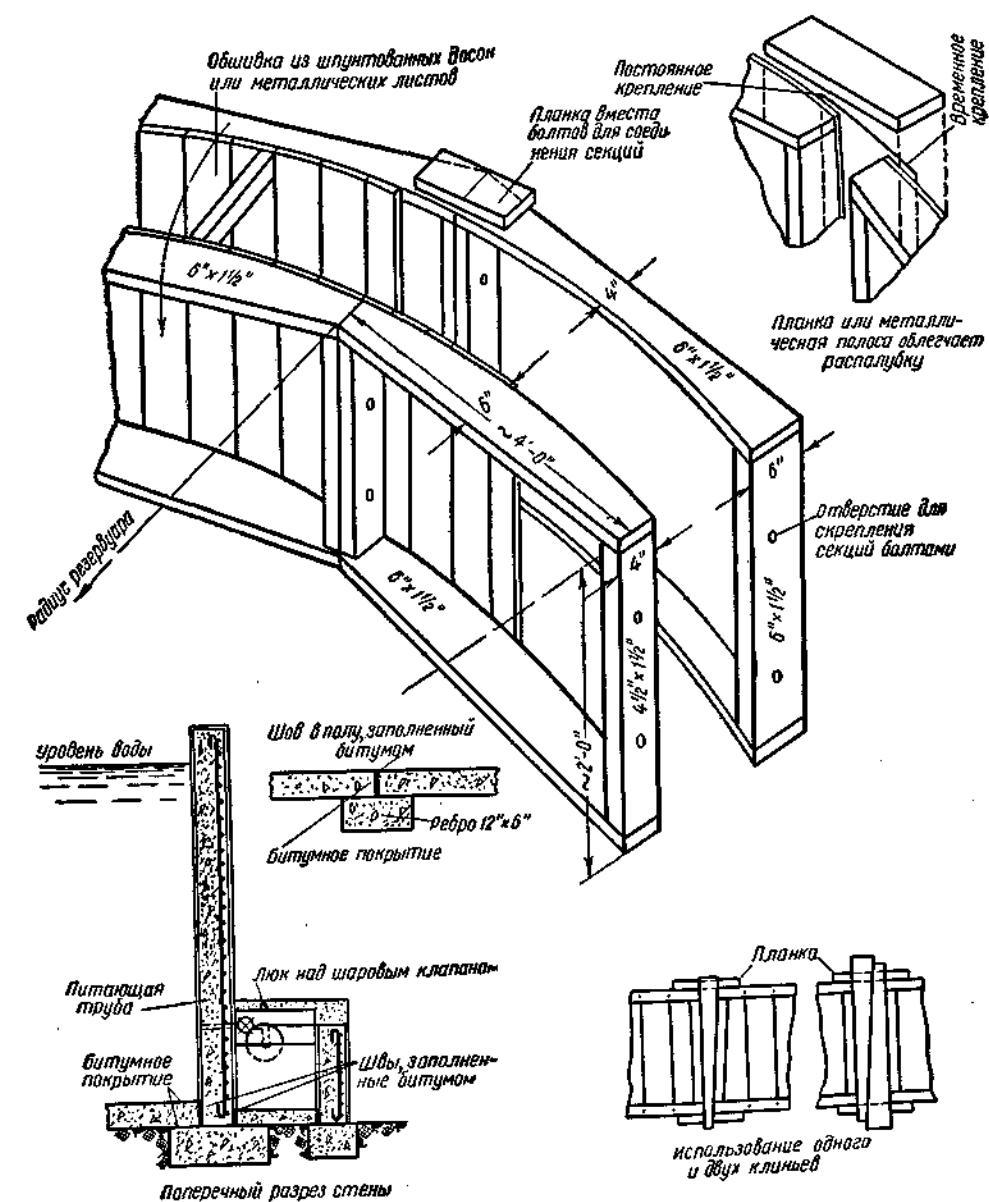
Опалубка для сооружения круглого бетонного резервуара.
